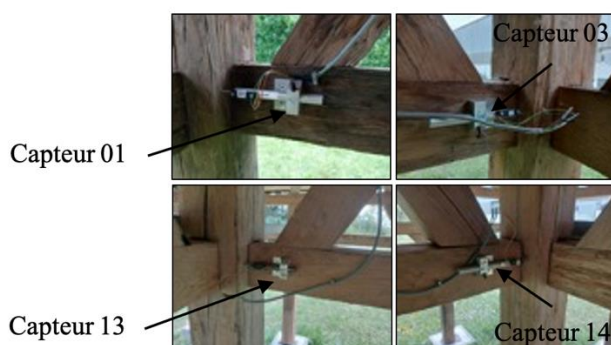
Disposition des capteurs entre le poteau d'angle et la poutre
